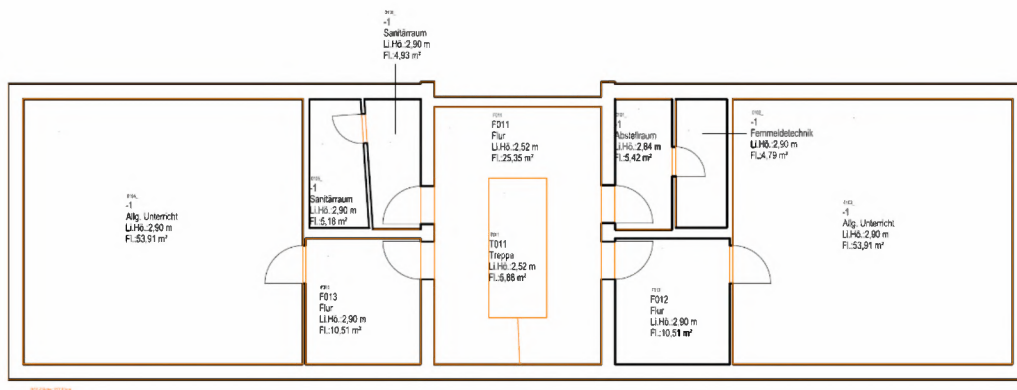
Grundriss 1. OG Gebäude 05, Quelle: Schulbau Hamburg
